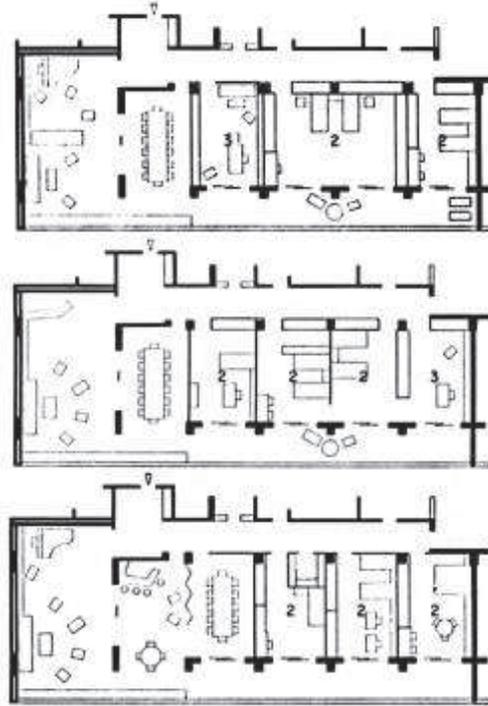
Planta do Edifício Prudência, Rino Levi, 1944.
